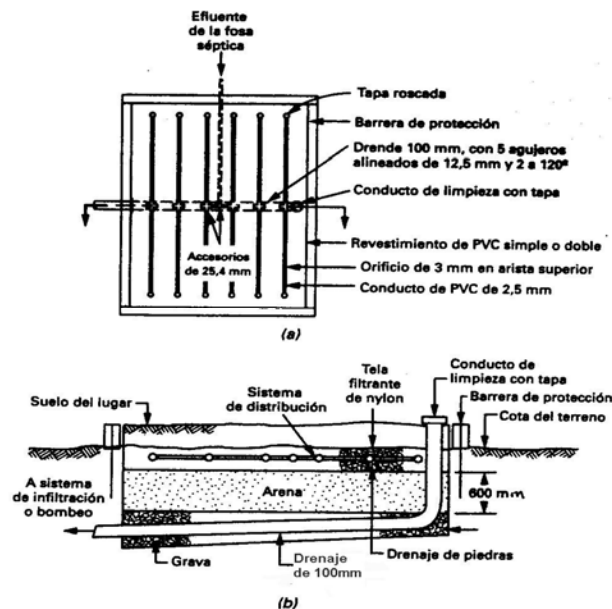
Esquema típico de un filtro de arena intermitente: a) vista en planta y b) sección.
